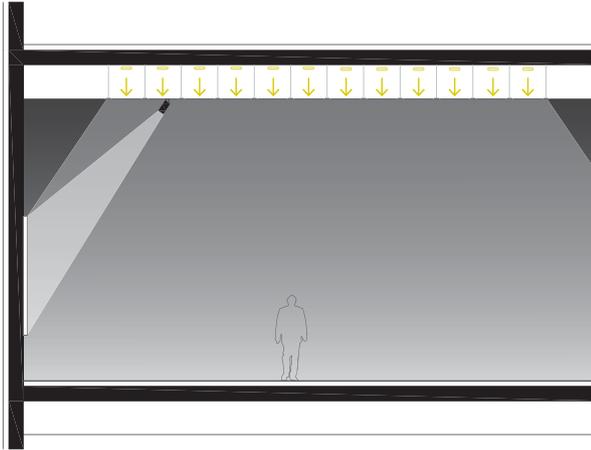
Lichtdecke mit Punktstrahler für ein Gemälde
